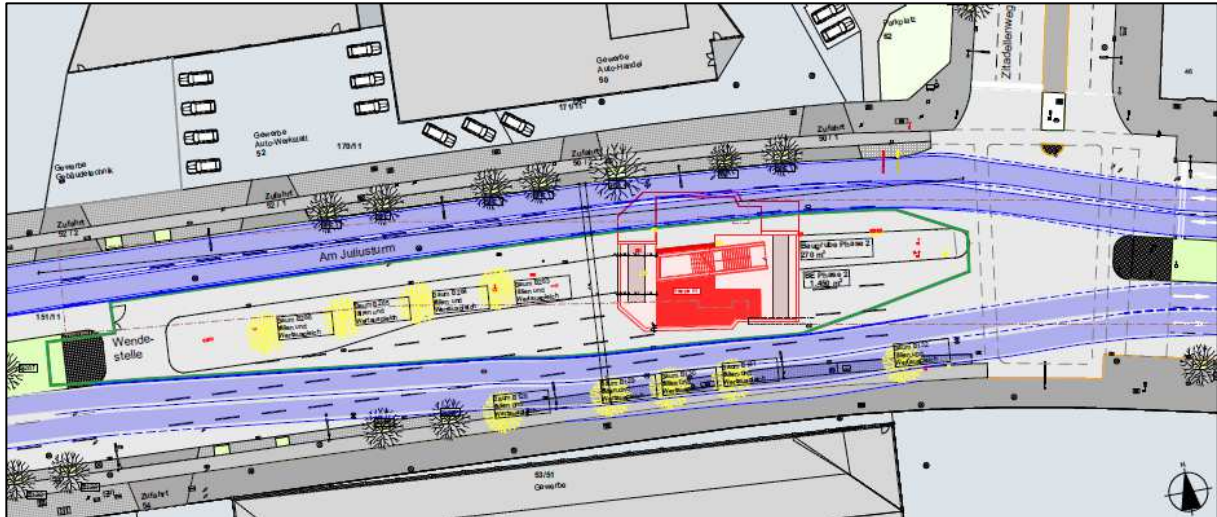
Ausschnitt Plan Zi\_PG 3a Baudurchführung (unmaßstäblich)
